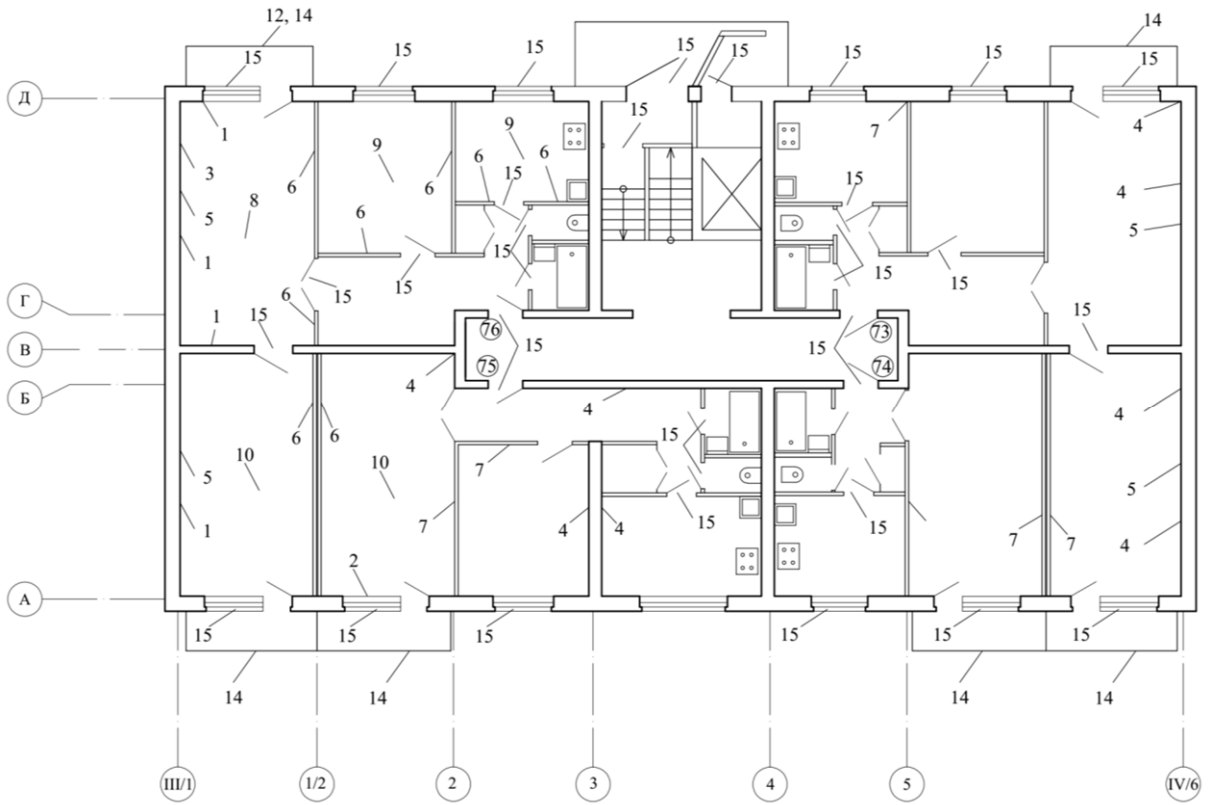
План першого поверху блок-секції № 3 будівлі
